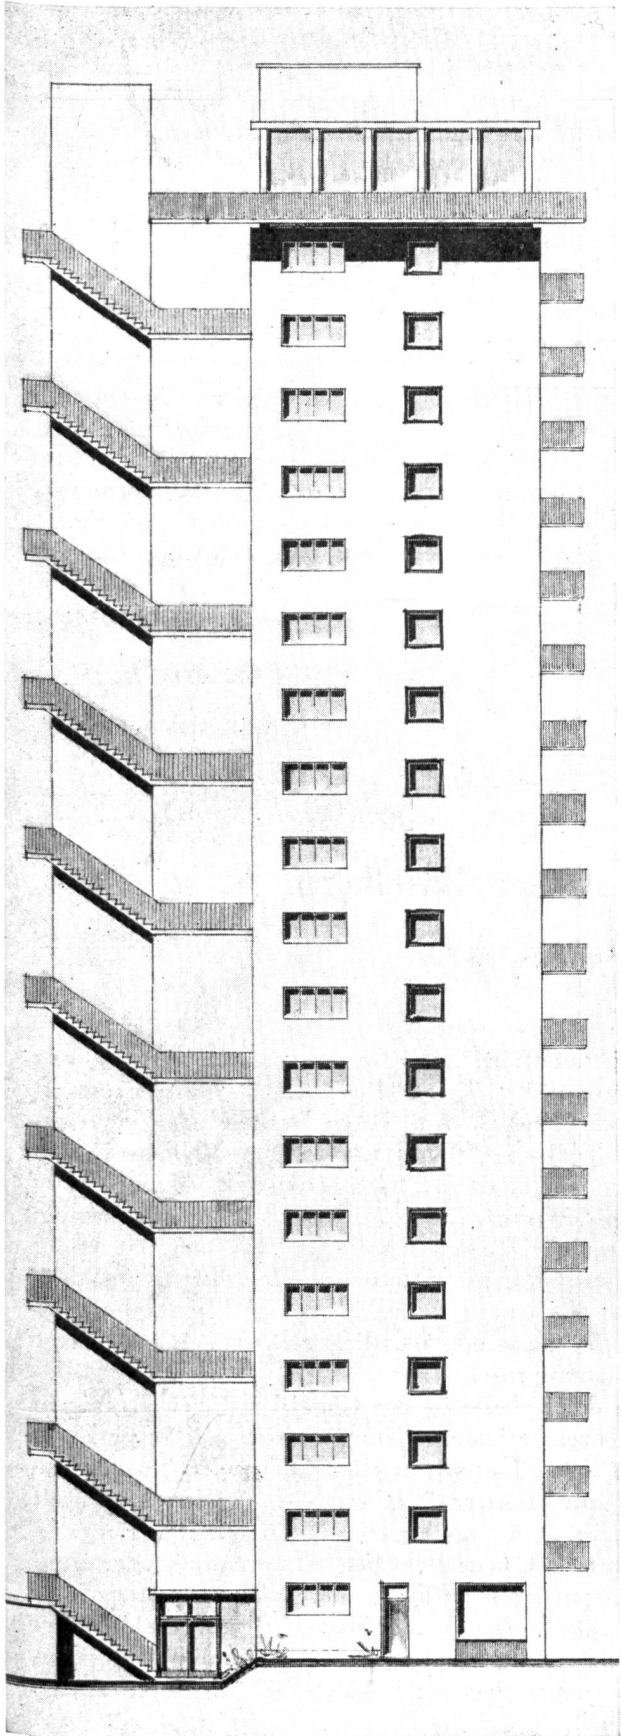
Südwestfassade mit dem angehängten Treppen- und Liftturm. Offene, um den Liftschacht geführte Treppe mit 90 cm hohem leichtem Geländer.
